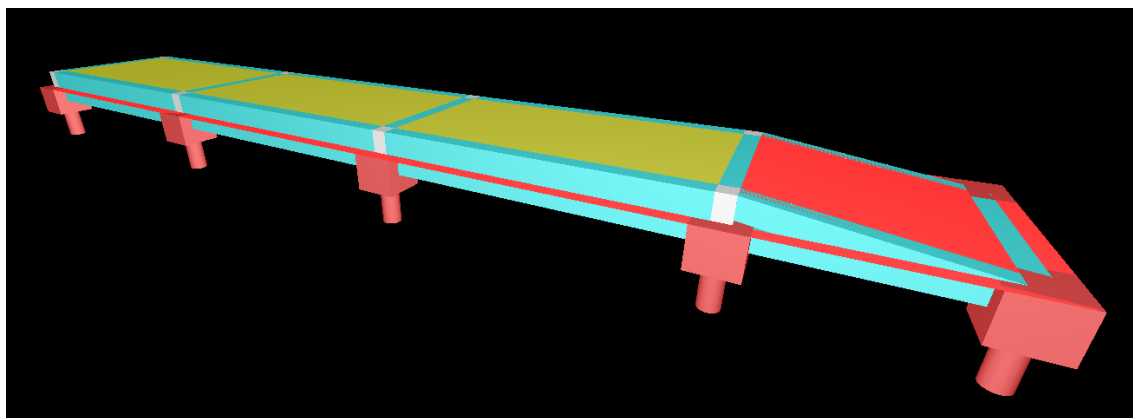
Imagem do esquema estrutural da base e rampa do Laranjal
